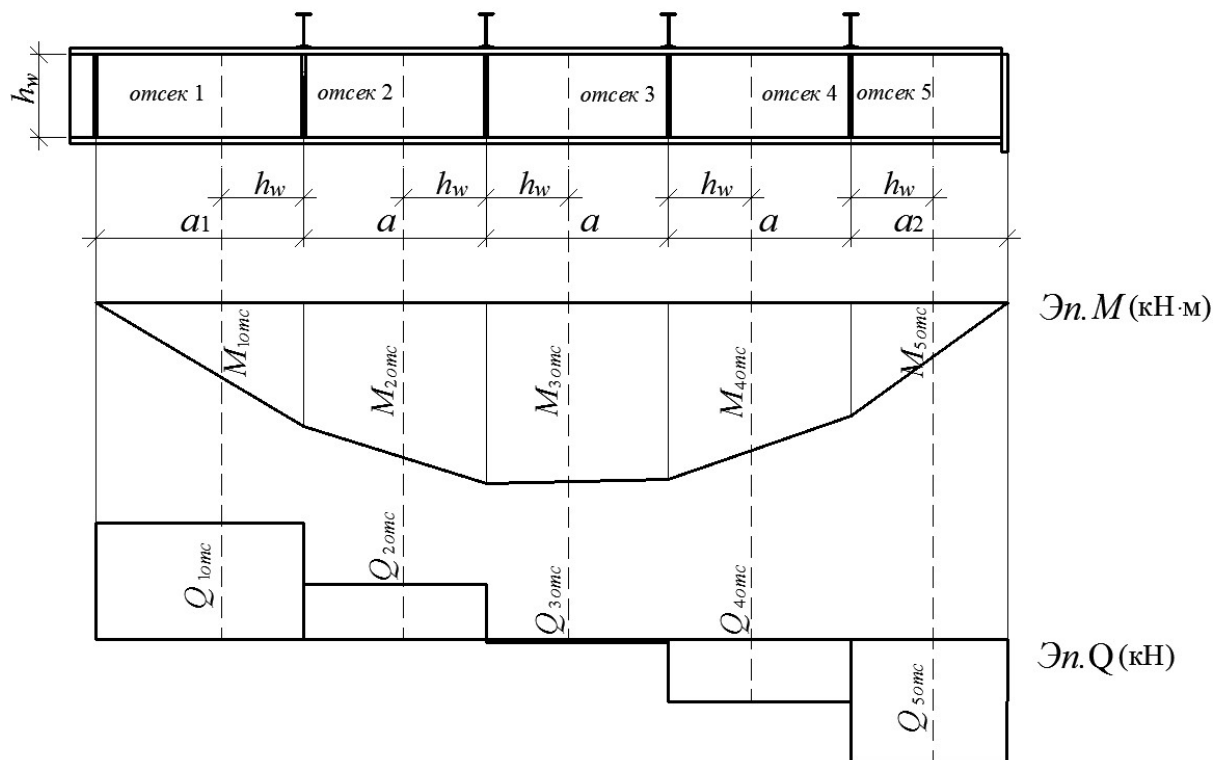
Схема балки с основными поперечными ребрами жесткости к расчету местной устойчивости стенки
